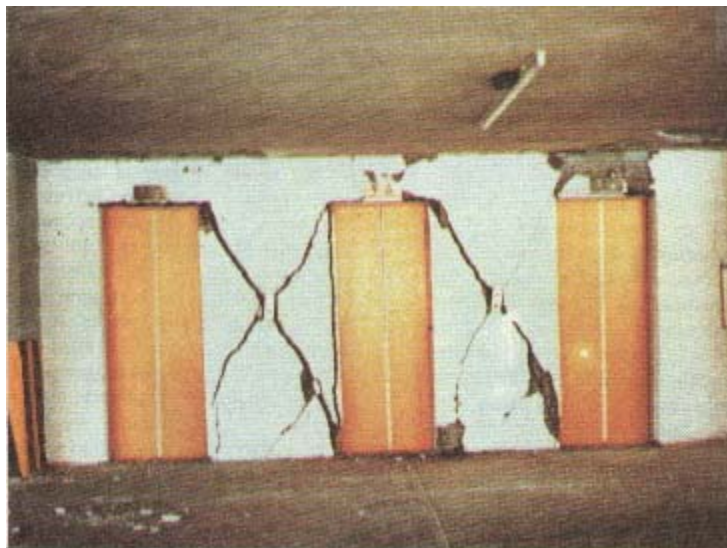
Fallas en muros (“Fundación ICA”, 1988)
